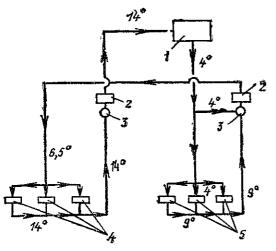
Схема водопровода установки для кондиционирования воздуха
